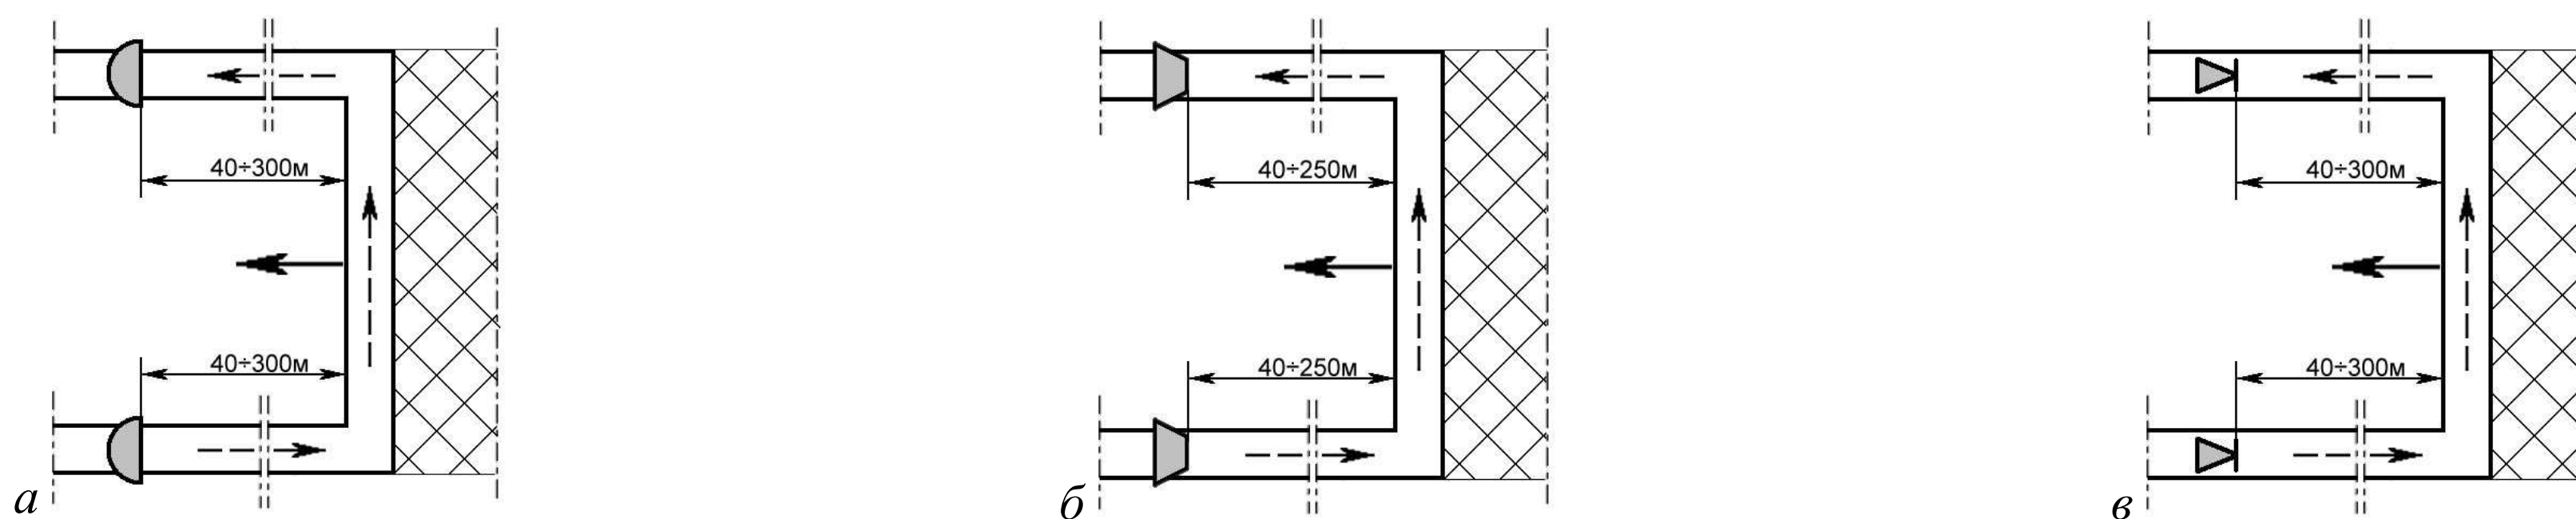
Схемы установки заслонов от сопряжения с очистной выработкой по ходу движения забоя в конвейерной и вентиляционной выработке с возвратной схемой проветривания
